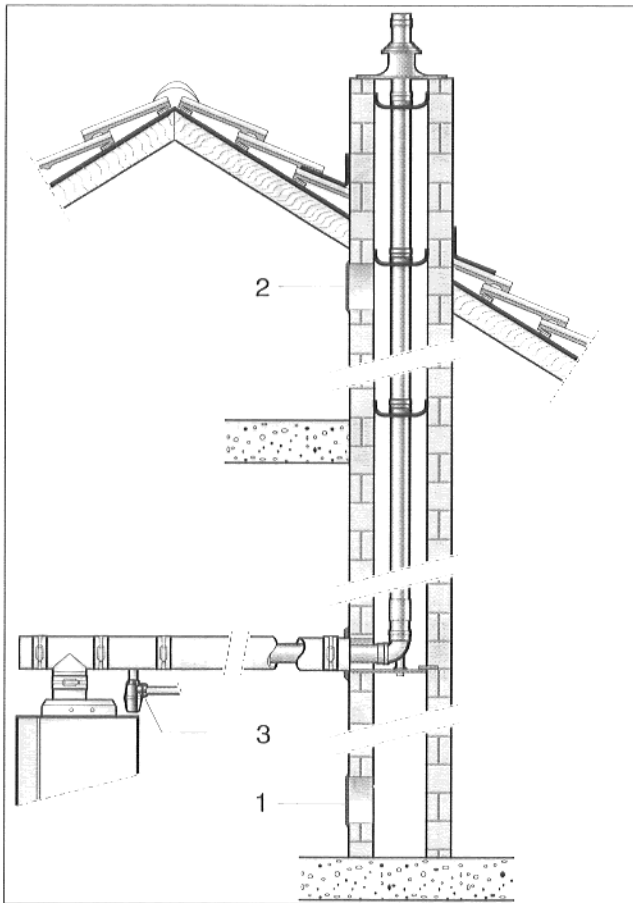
Grundbausatz GA-K für U104 WG/WKG, Abgasführung mit Aluminium-Rohren
